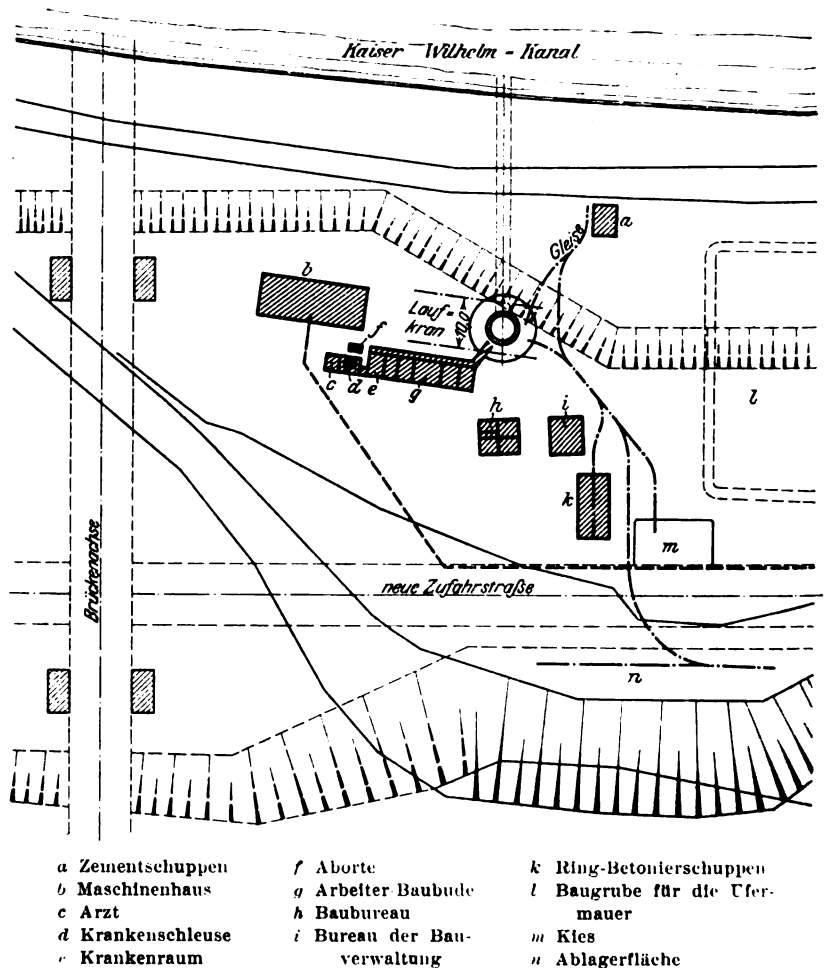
Lageplan der Baustelle. Maßstab 1:1500.
